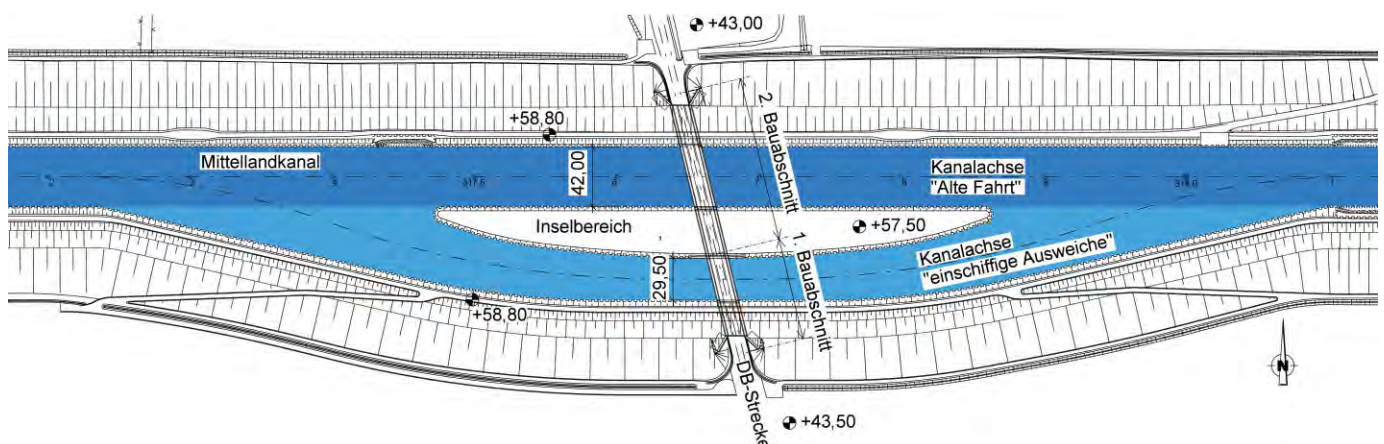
Lageplan: Neubau als Brücke in Standardbreite in Alter Fahrt mit einschiffiger Ausweiche in Neuer Fahrt
